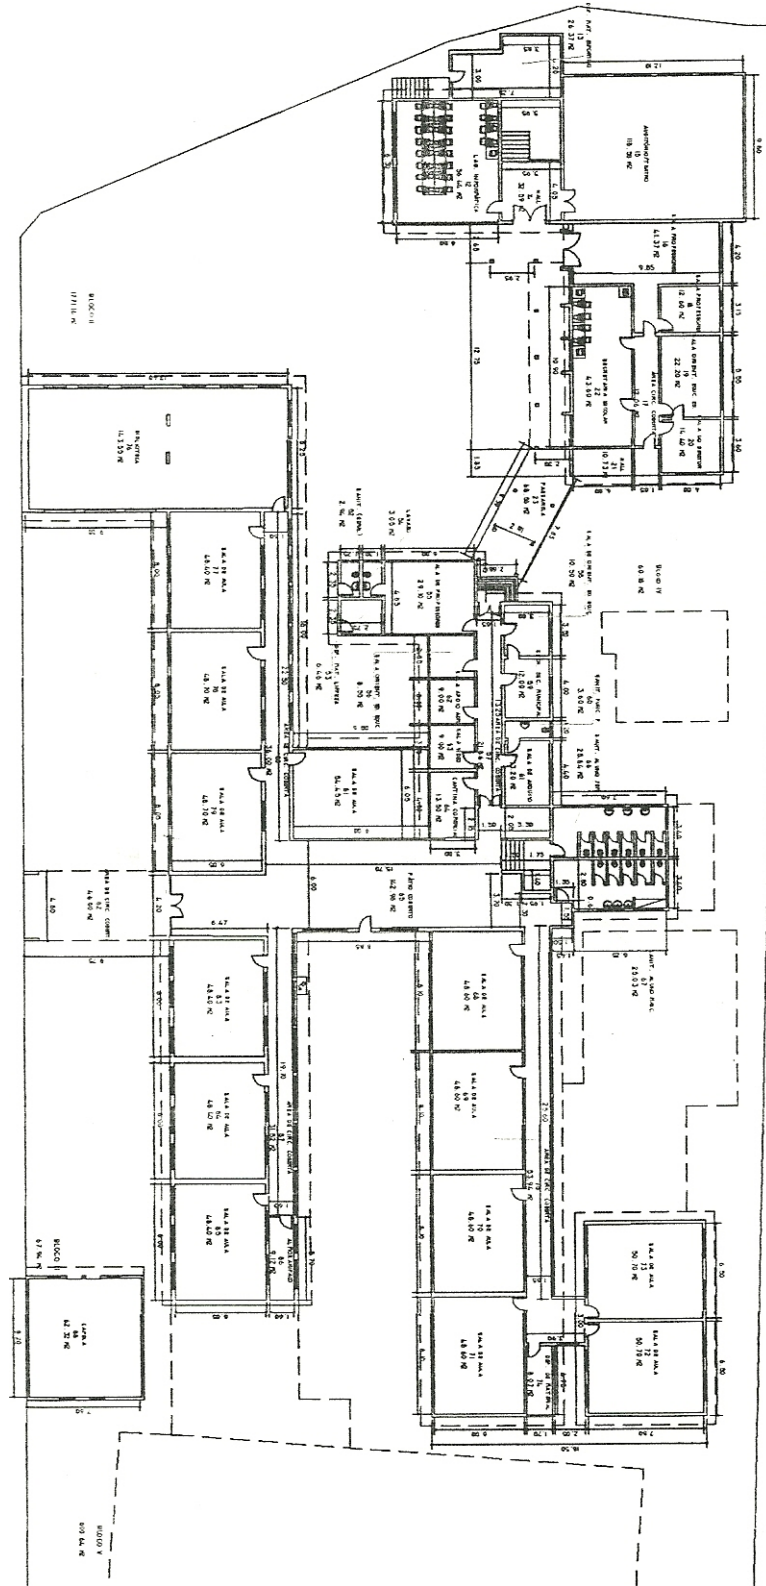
Cet Izidoro Luiz Cerávolo – 1º Pavimento
